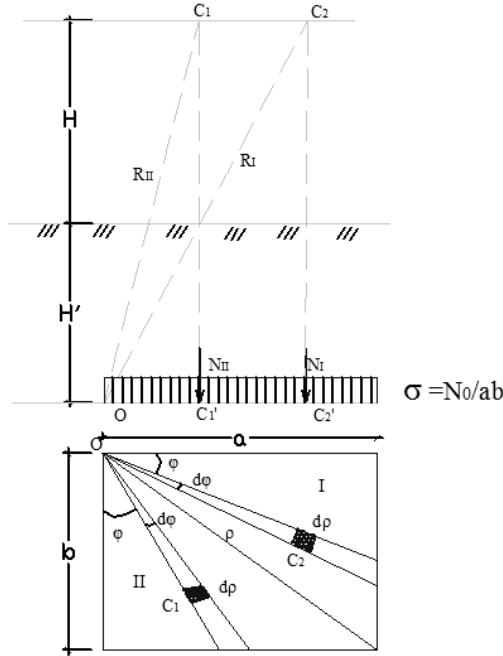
Схема к определению осадки заглубленного фундамента
